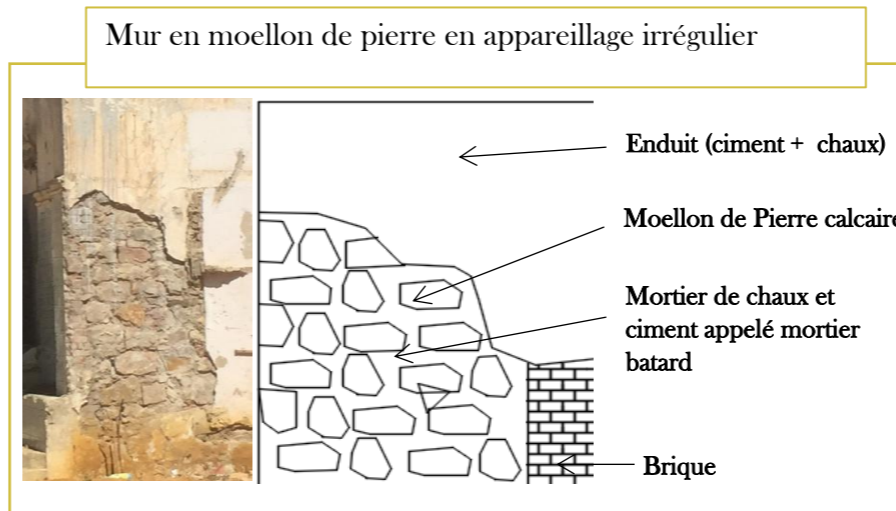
Détail mur en pierre. Source : BET Handassa wa Biana annoter par l'auteur.
